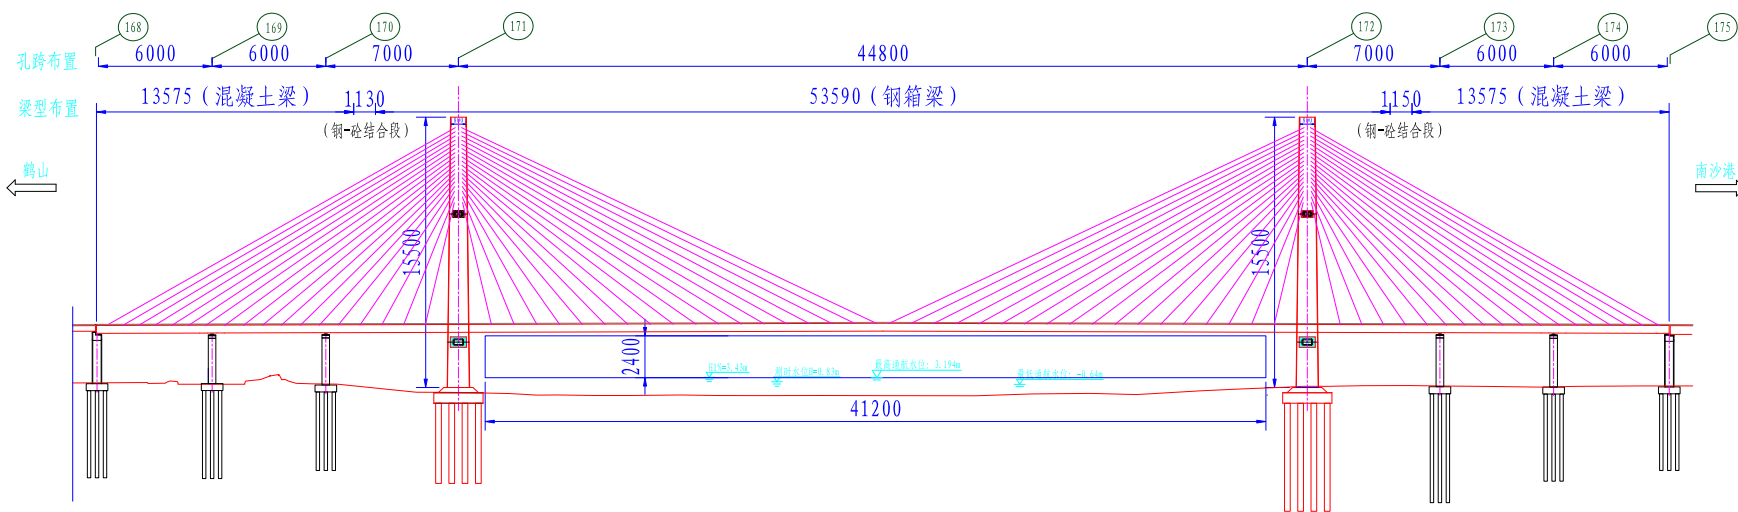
龙穴南水道特大桥主桥桥式立面布置图
